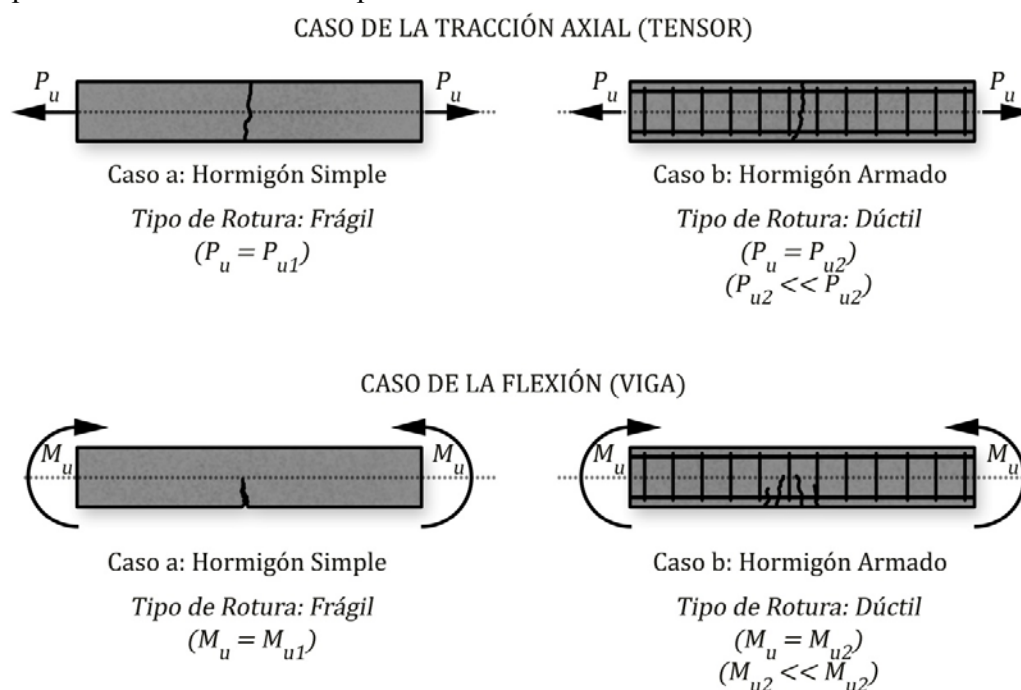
Efecto del refuerzo en la Fisuración del hormigón
